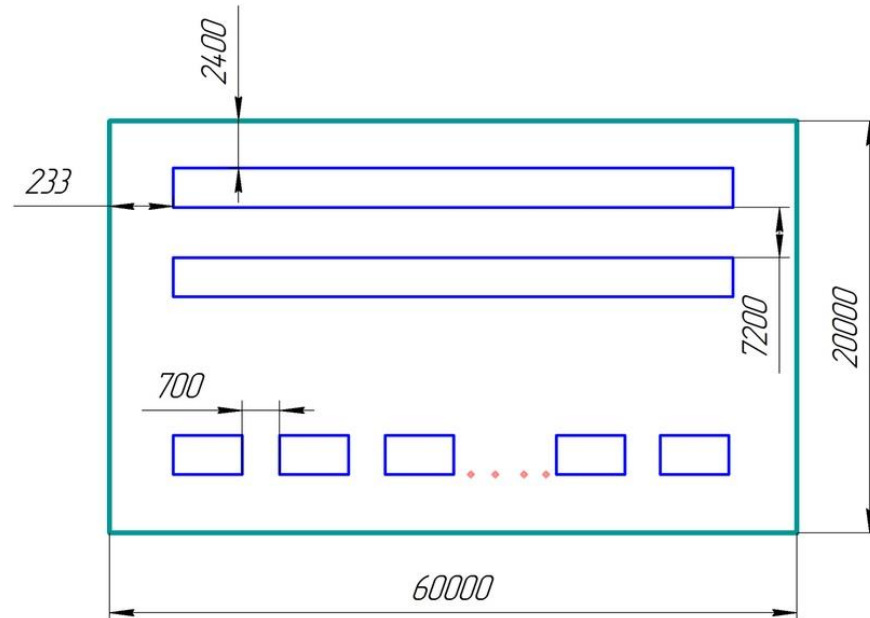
План размещения светильников с люминесцентными лампами
